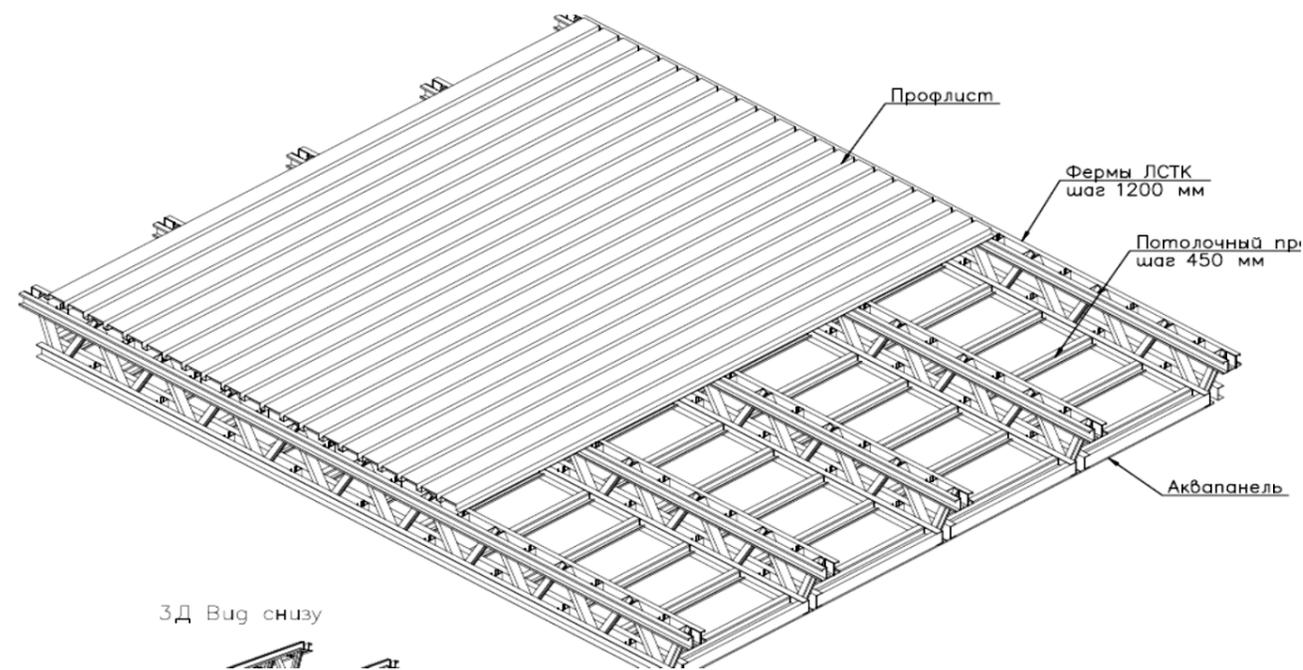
Перекрытие по прогонам из балочных ферм собранных из стальных тонкостенных швеллеров.
